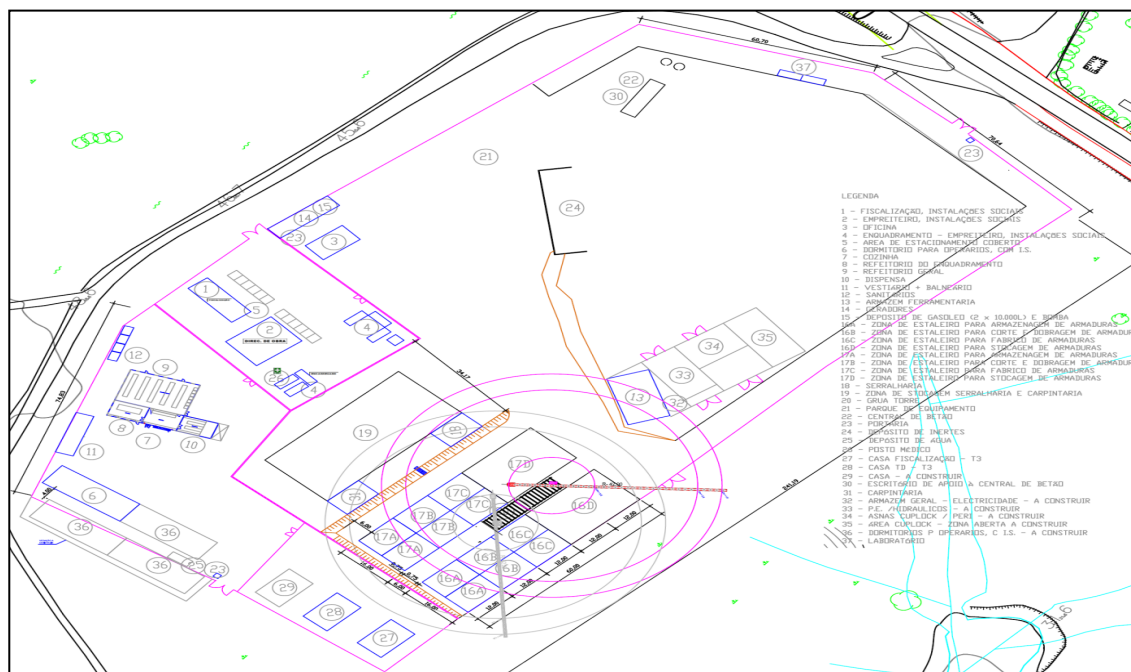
PLANTA GERAL DE ESTALEIRO
